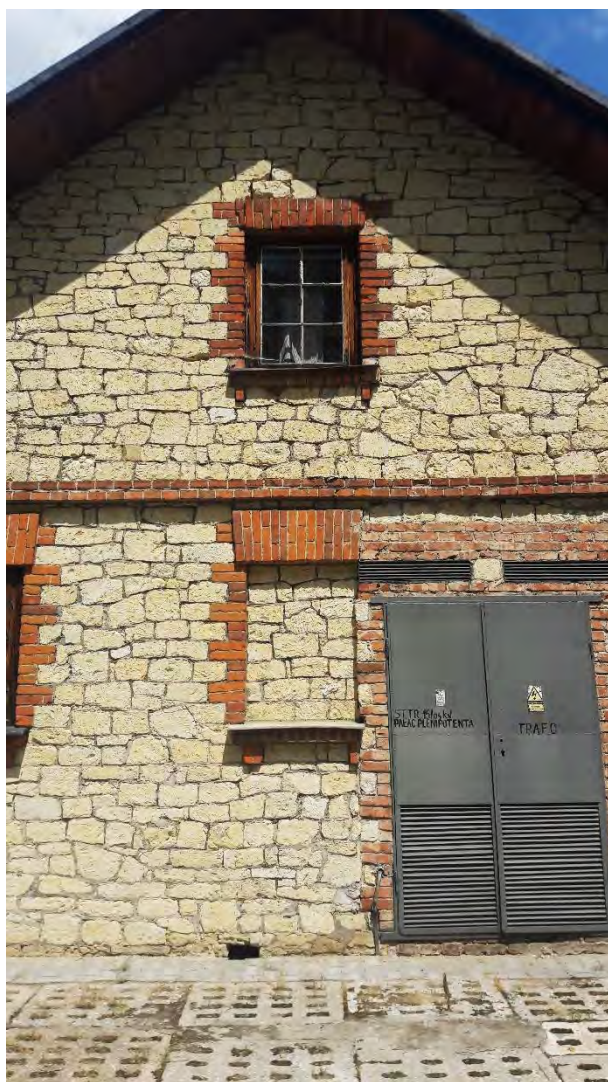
Elewacja frontowa - widok od strony zachodniej
